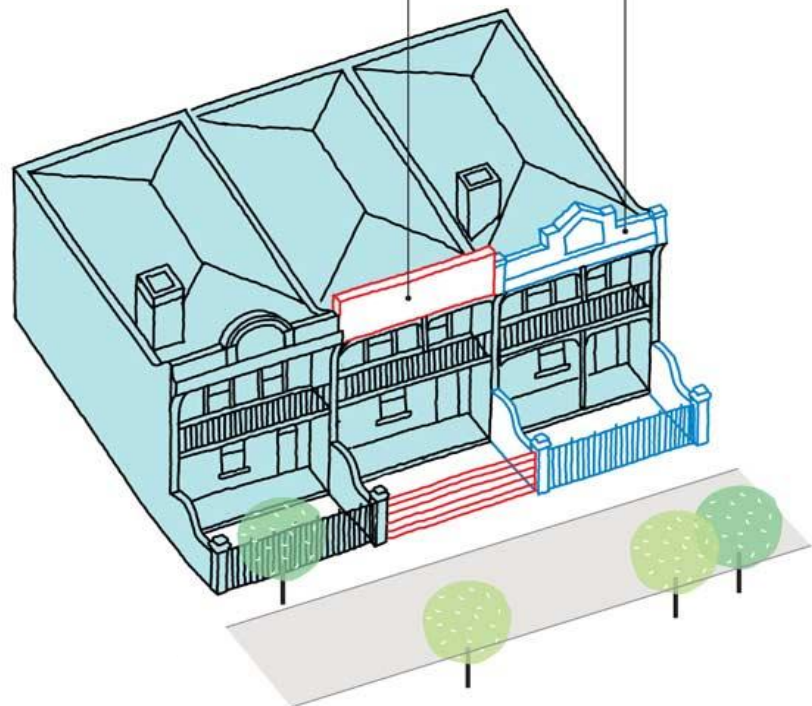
Contoh bangunan rumah kedai yang mempunyai elemen ragam hias yang unik pada fasad bangunan.
